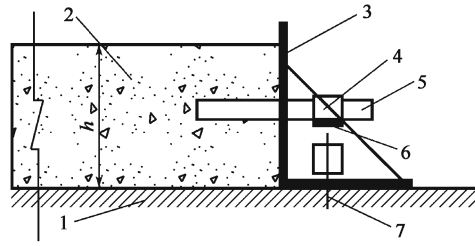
Elévation latérale du coffrage d'extrémité d'un joint de construction
